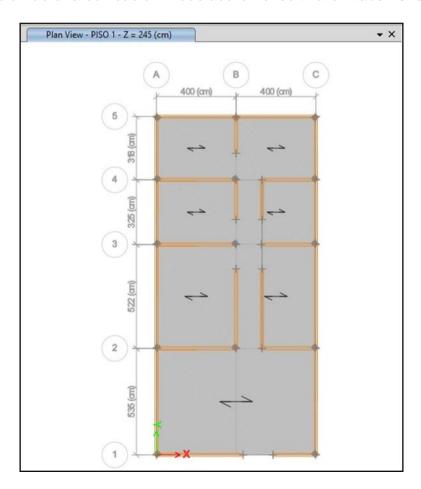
Modelamiento en planta de la Edificación. Tomado de Elaboración Propia.
